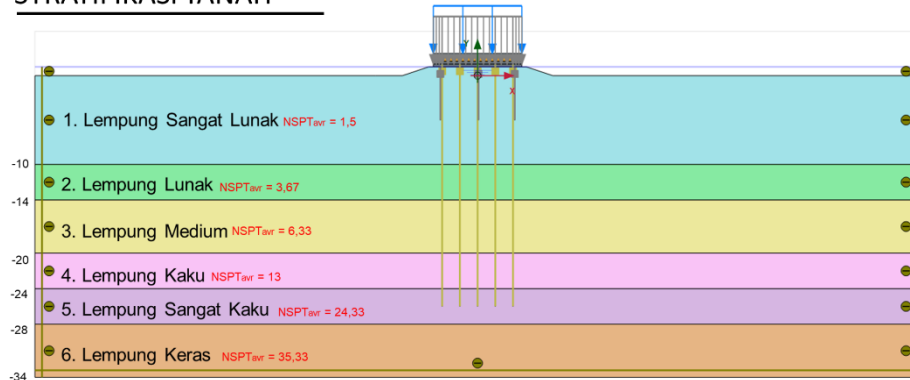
Tipikal penanganan alternatif 2: Pile Embankment+Timbunan Tanah
